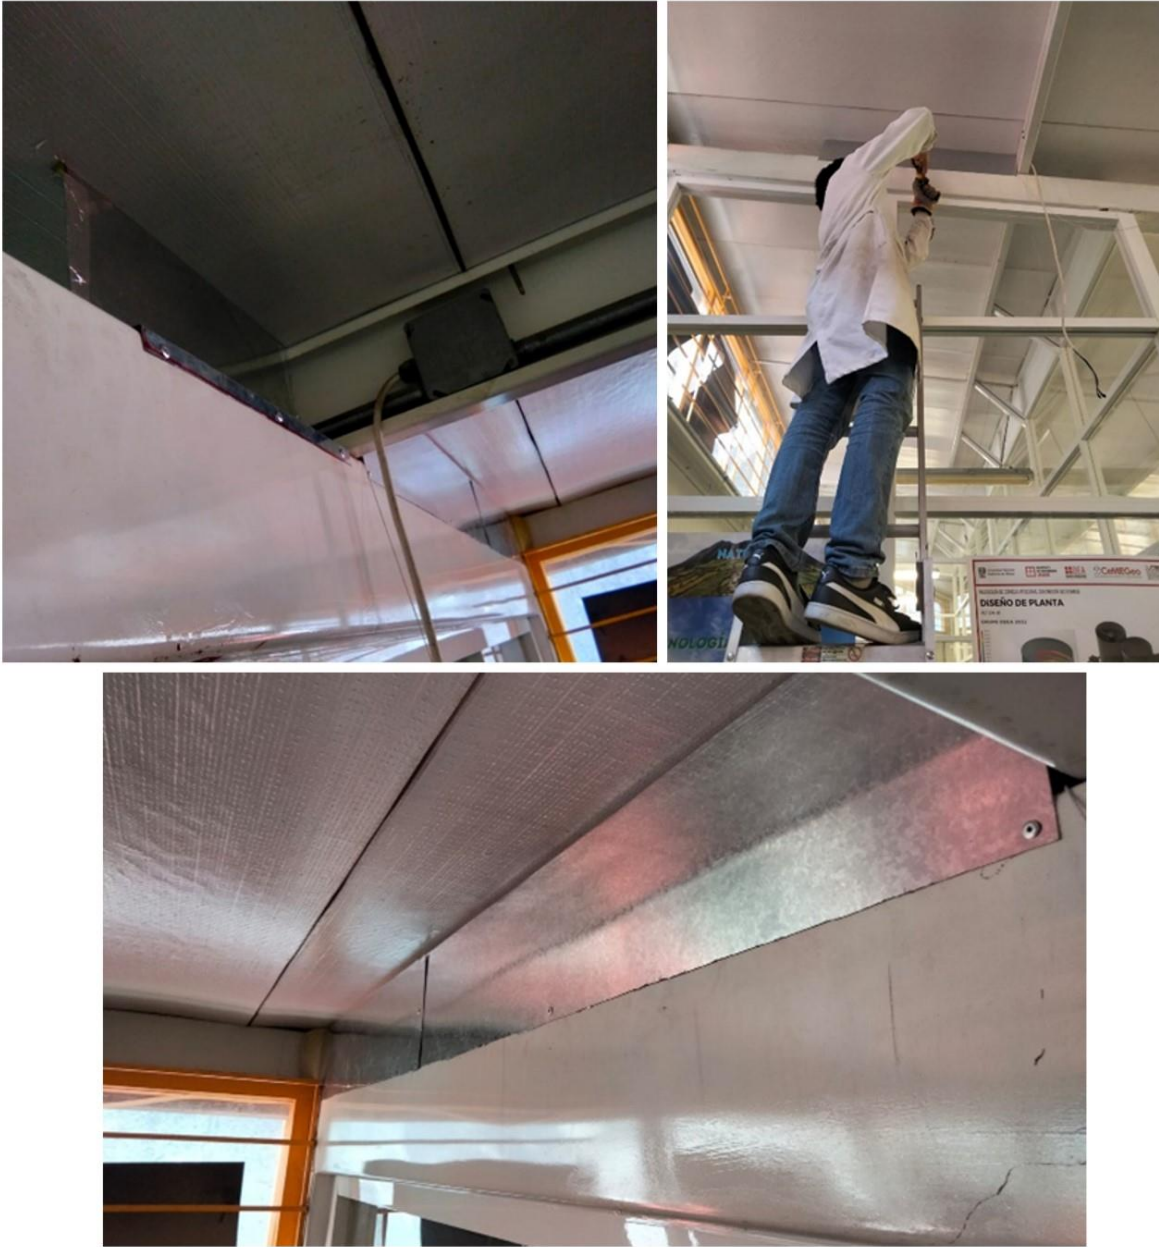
Instalación final de estructuras aislantes de paredes Norte y Sur
